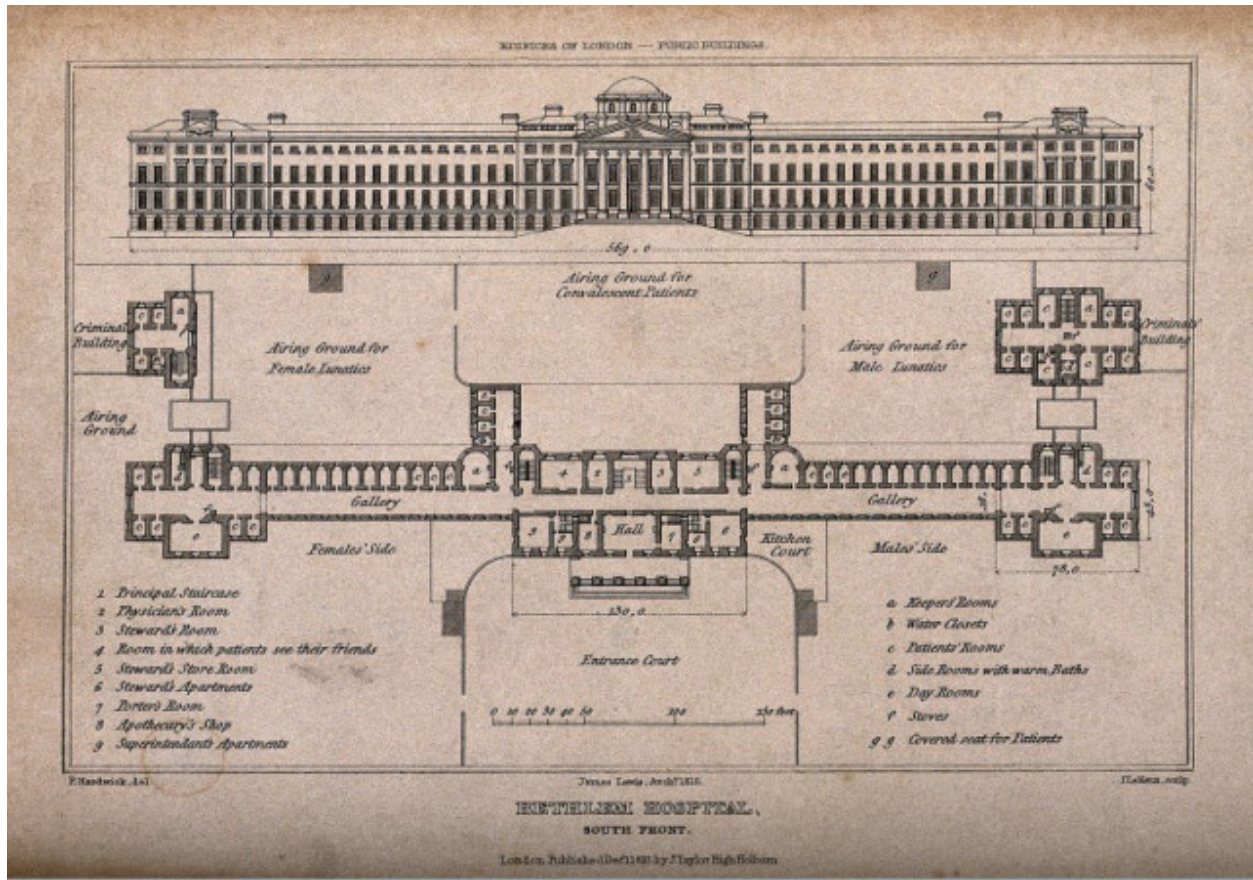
Elevación y Planta de Hospital Bethlem, 1823.
